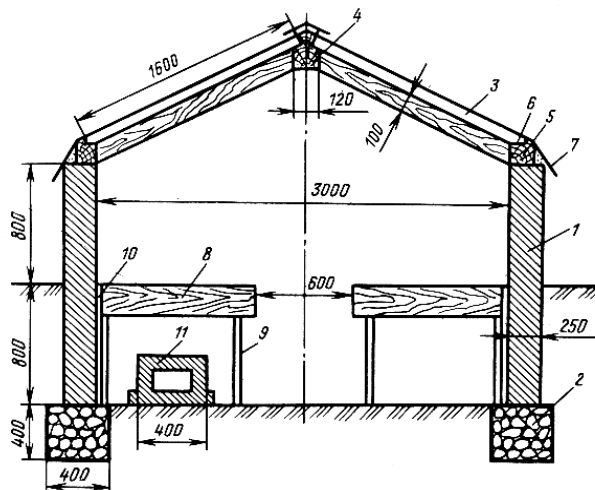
Зимово двосхіла теплиця: 1 – стіна; 2 – фундамент; 3 – стропила; 4 – коньковий брус; 5 – перев’язочний брус; 6 – паз для впирання рам; 7 – відлив; 8 – стелаж; 9 – стійка стелажу; 10 – отвір між стіною і стележем; 11 – димохід
